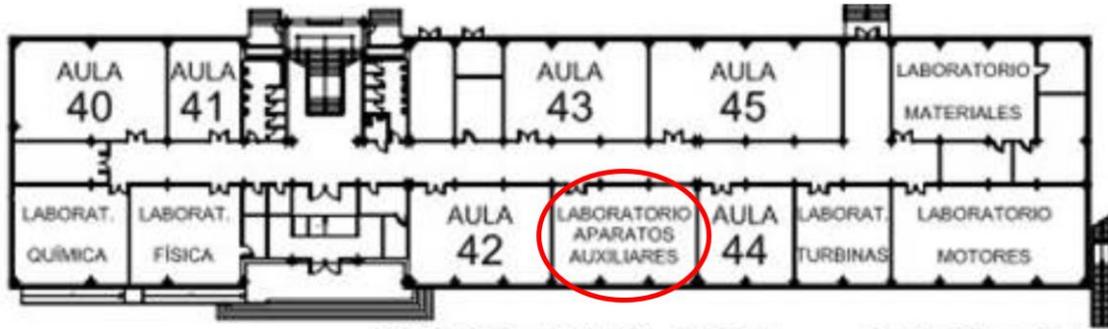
Plano edificio Isaac Peral, planta baja [14].
